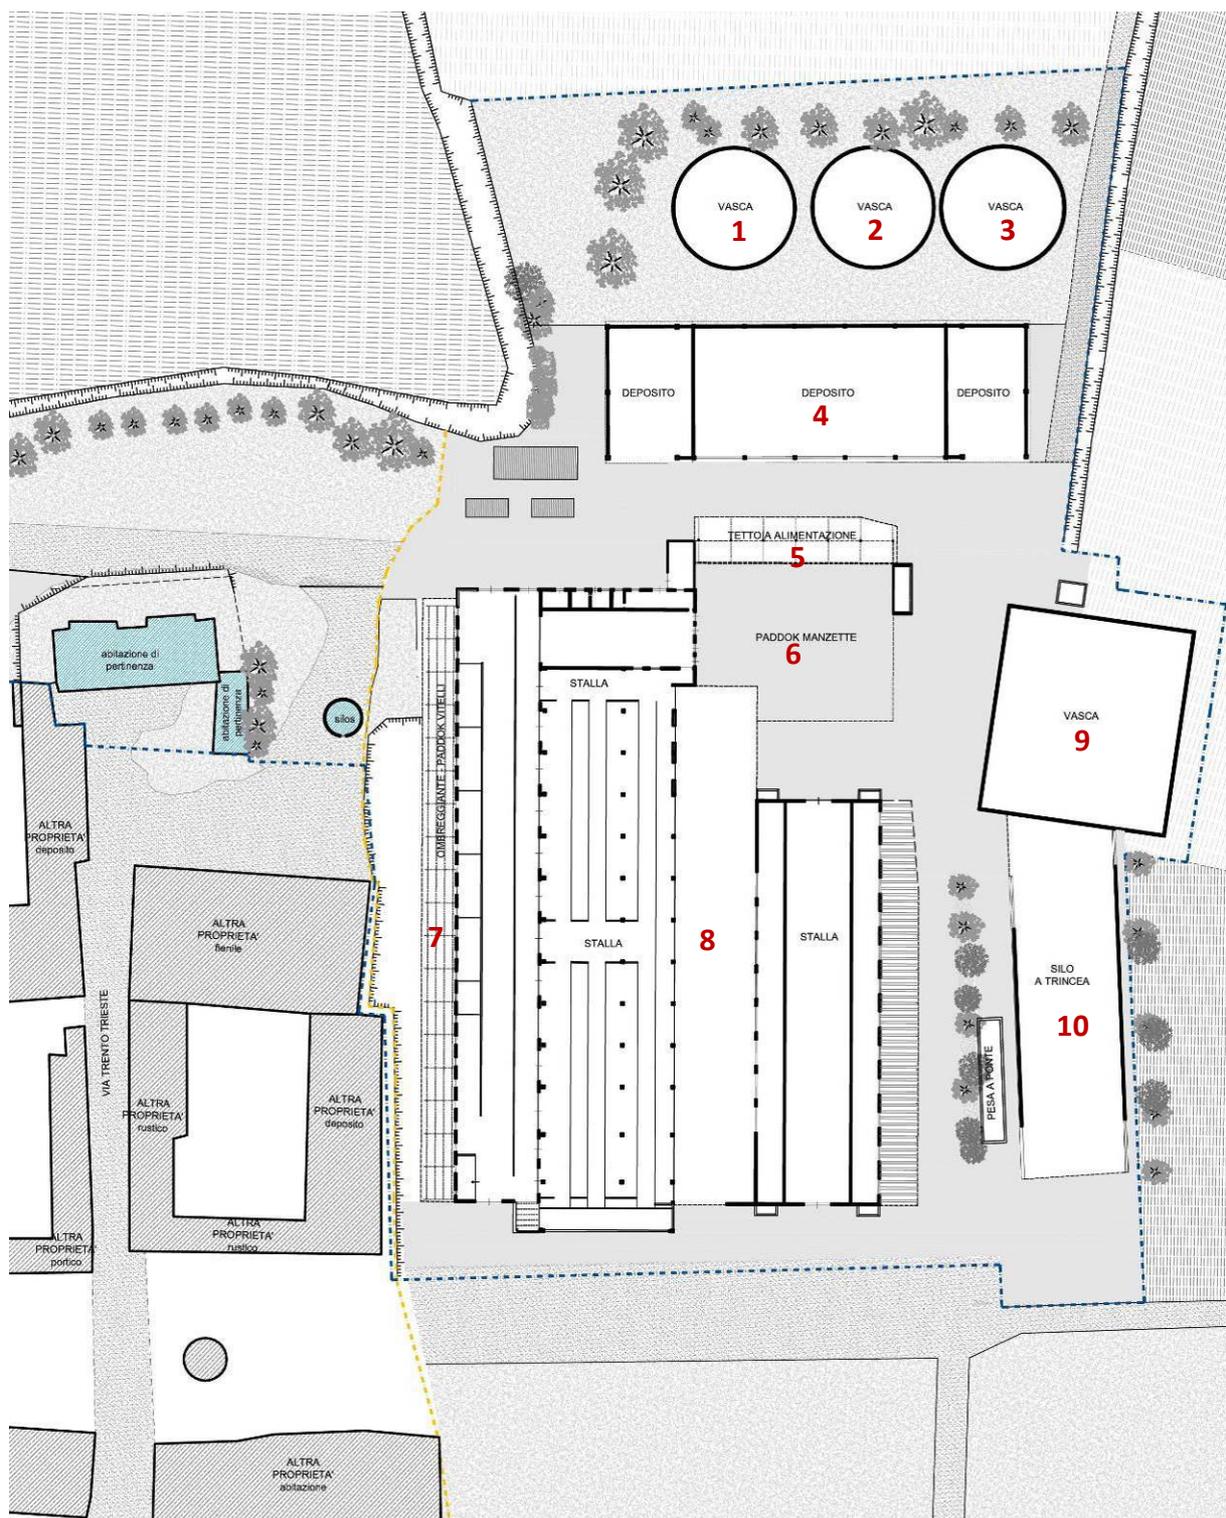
Planimetria dello stato di fatto dell'azienda:
